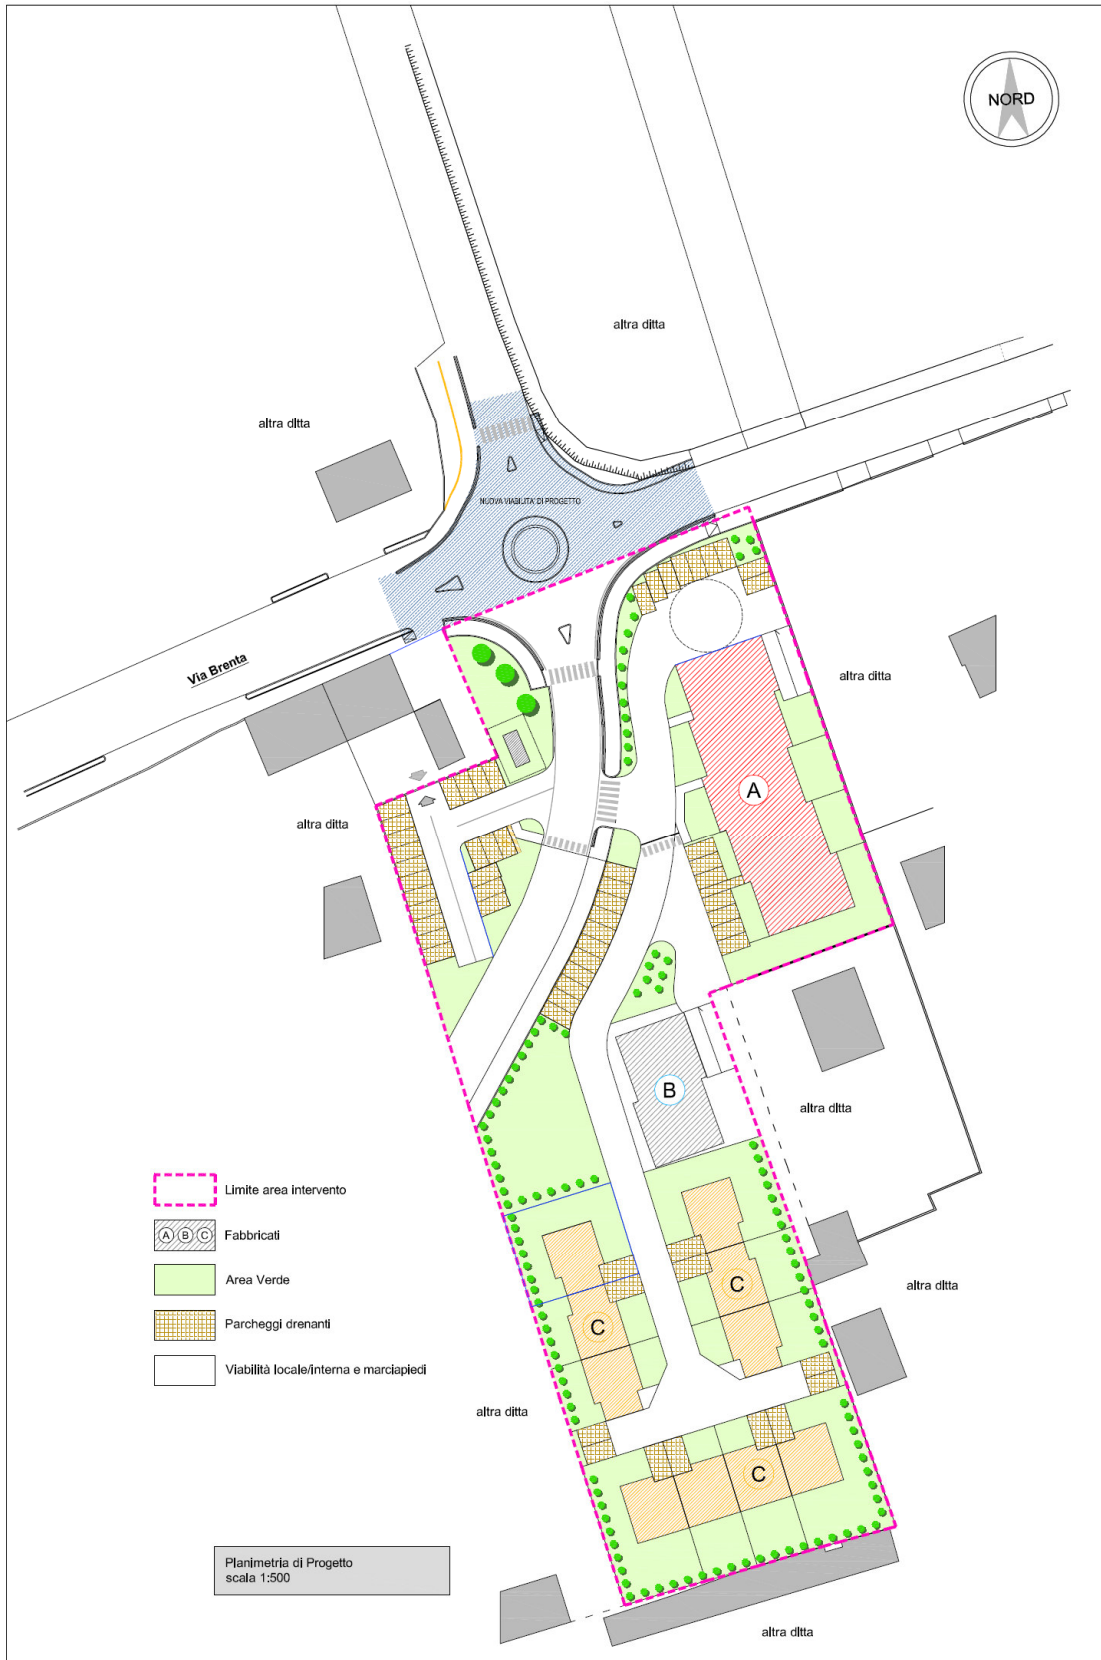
Planimetria dell'area in esame con suddivisione delle superfici.
